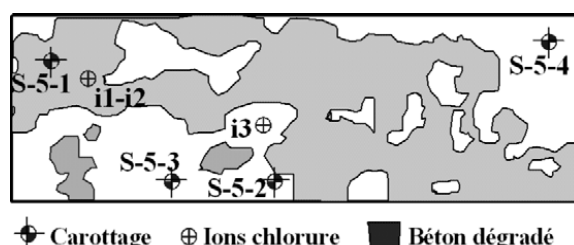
Inspection visuelle d'une dalle en béton armé (Dous, 2002)
